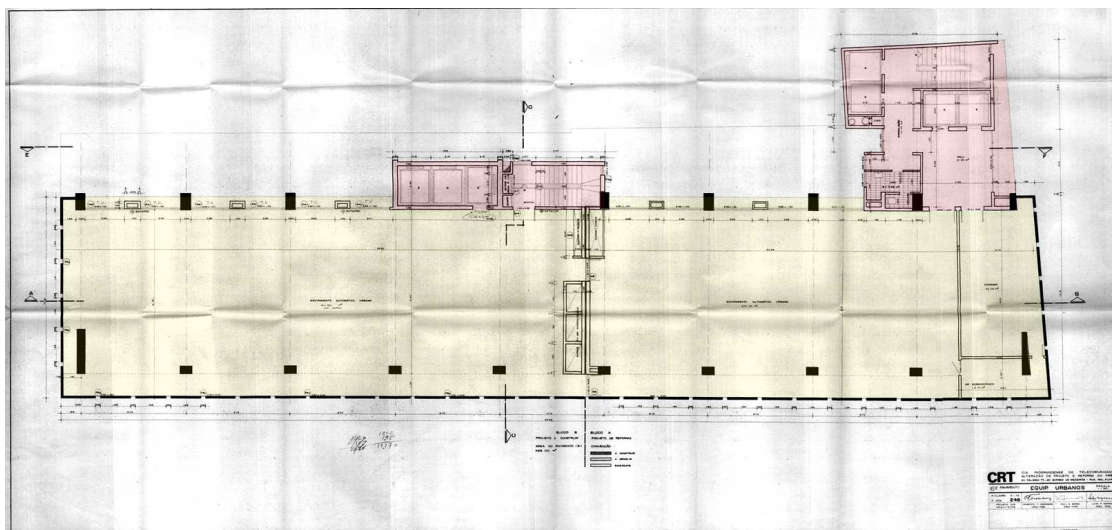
Planta do 5º, 6º e 7º pavimentos. Projeto de março de 1972.
